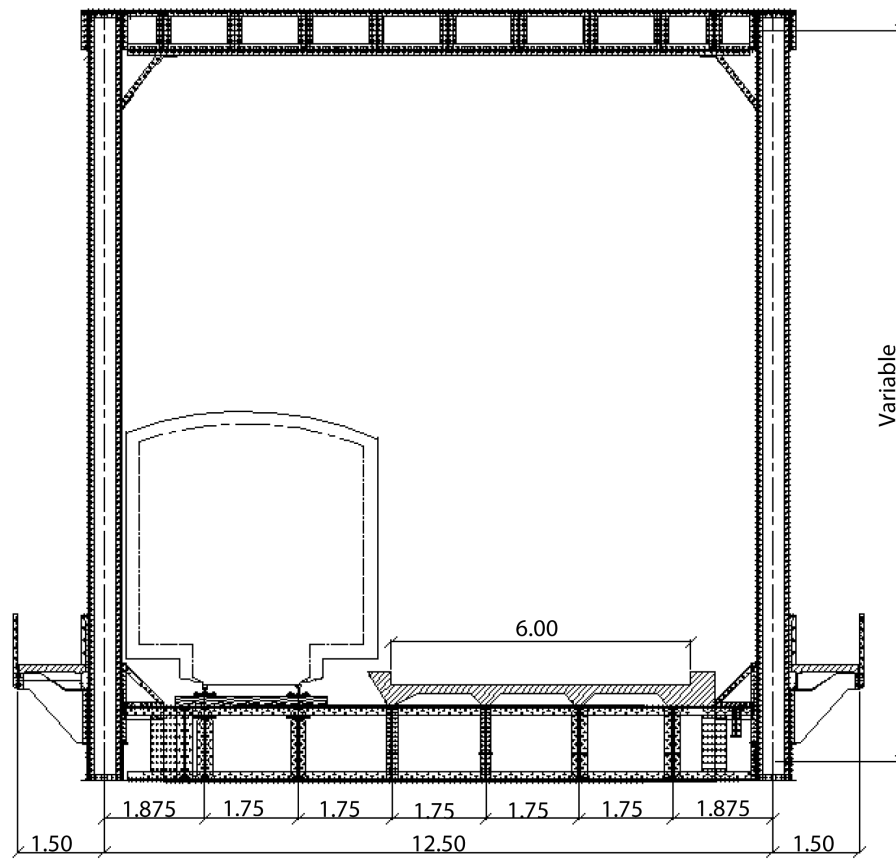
b : Coupe transversale du pont-rails de Marazeek.
